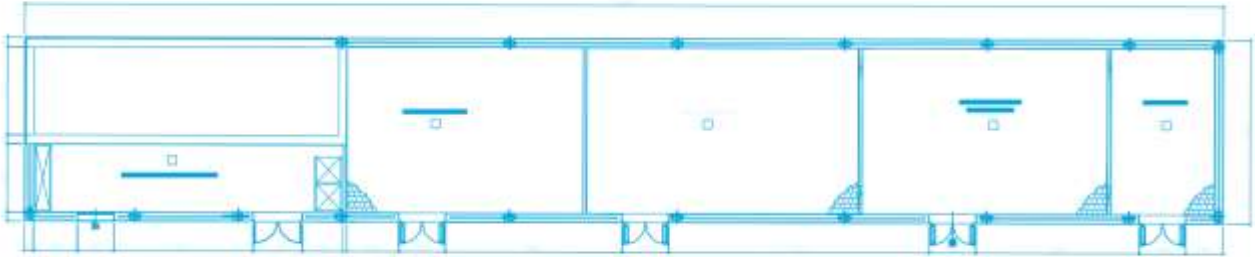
Pianta piano terra del fabbricato FA1L nel Progetto approvato
